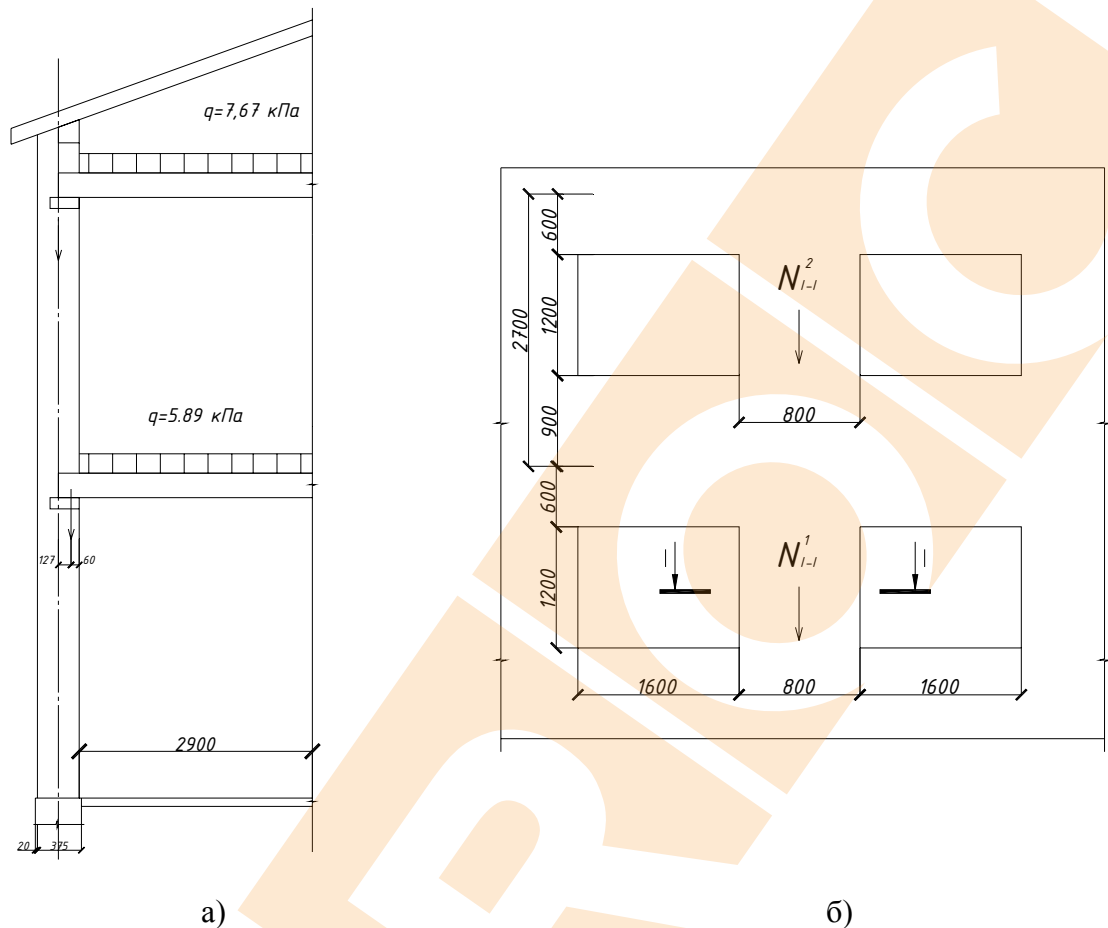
Схема навантаження простінку: а) розріз; б) фасад
